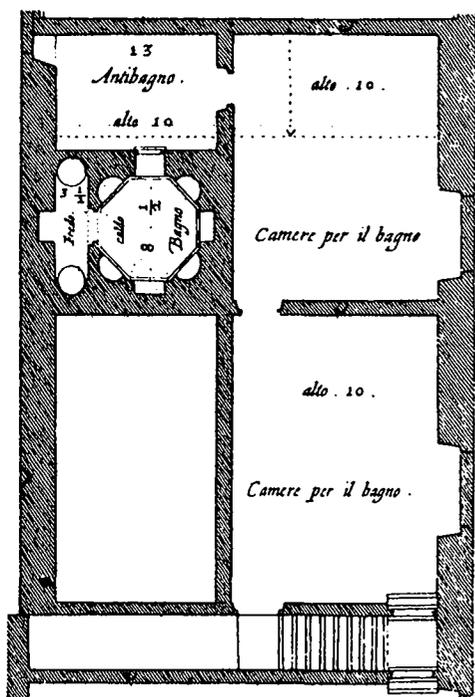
Détail en plan de l'étage comprenant la salle de bain qui figure sur la coupe transversale de la page précédente.
